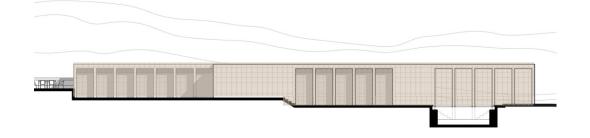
Corte longitudinal de "Villa Chams" proyecto de Carl Gerges Architects. Plano de: Carl Gerges Architects.
